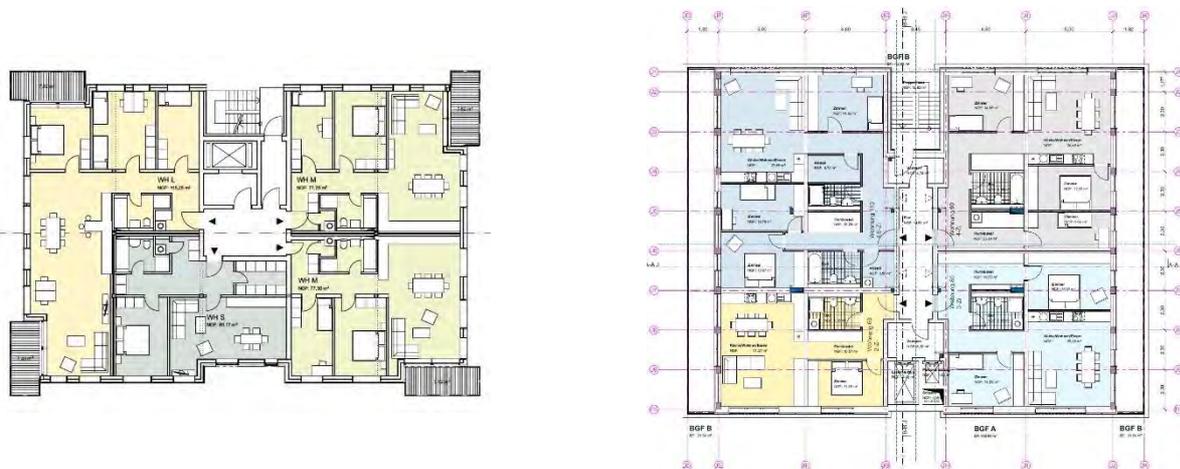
ursprünglicher Grundriss (li.); abgeänderter Grundriss (re.)
